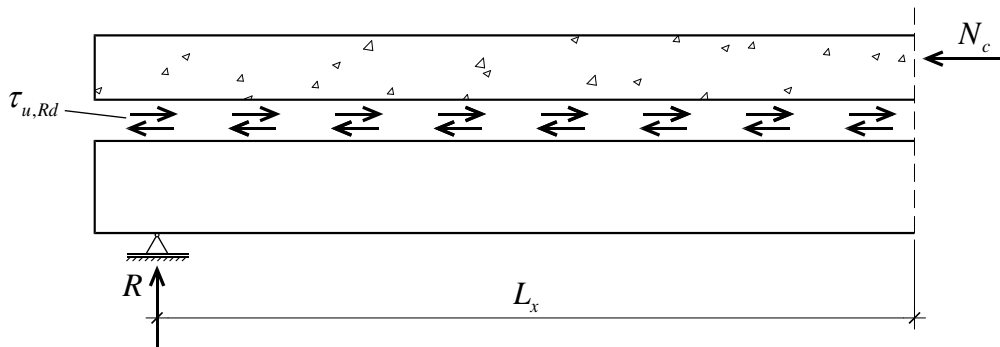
Forças atuantes num segmento de laje mista (adaptado de PATRICK; BRIDGE, 1990).
